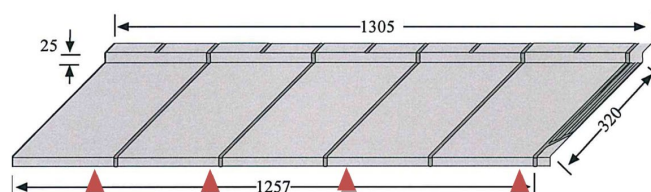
METROTILE® ELEGANTA dakpan - plaatsing van de bevestigingen
